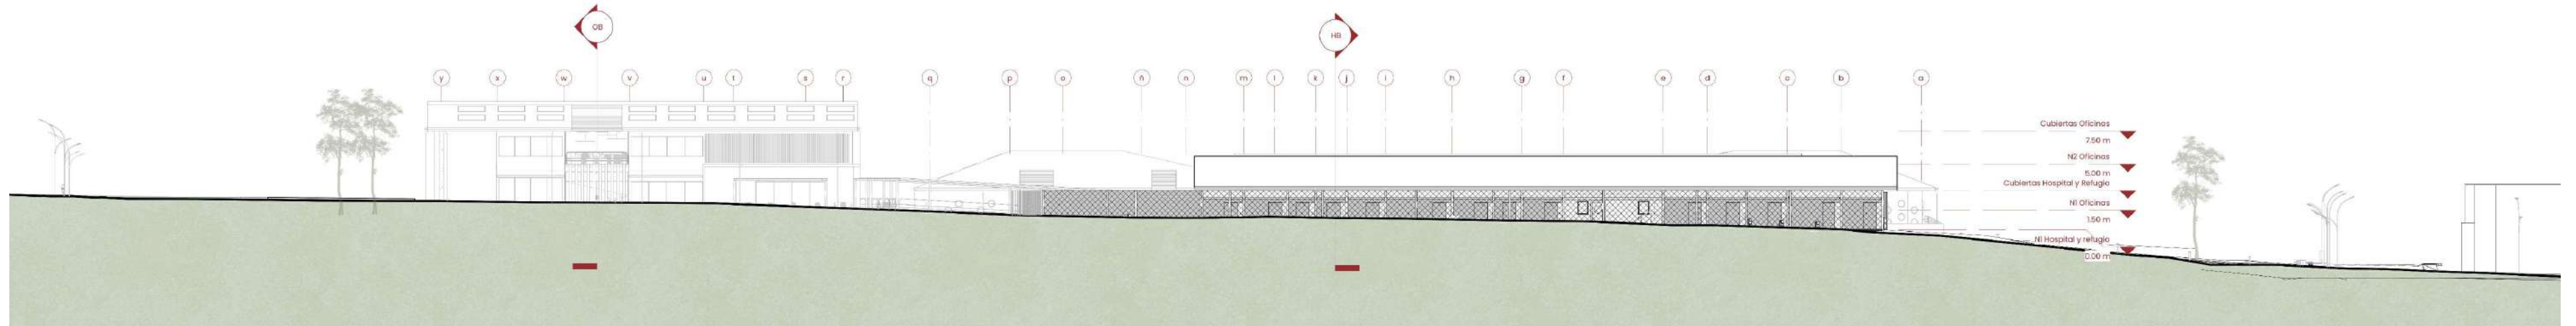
Fachada posterior (Norte). Fuente: Elaboración propia
